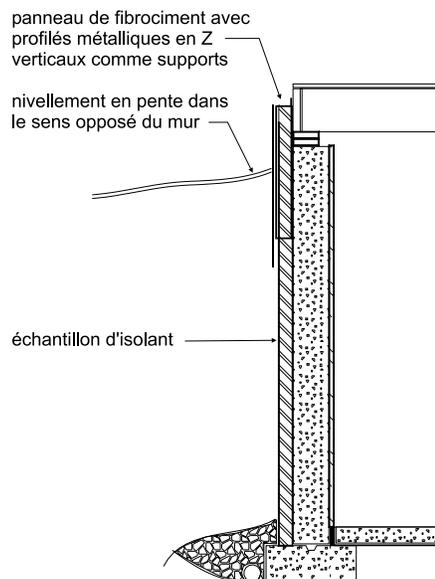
Coupe de l'autre mur d'essai sous-sol avec supports verticaux pour panneau de fibrociment et nivellement en pente dans le sens opposé du mur (bon aménagement paysager)
